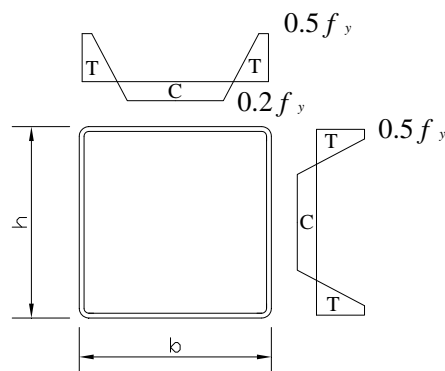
Tensões residuais em secções ocas [13]: C – compressão; T – tracção.
